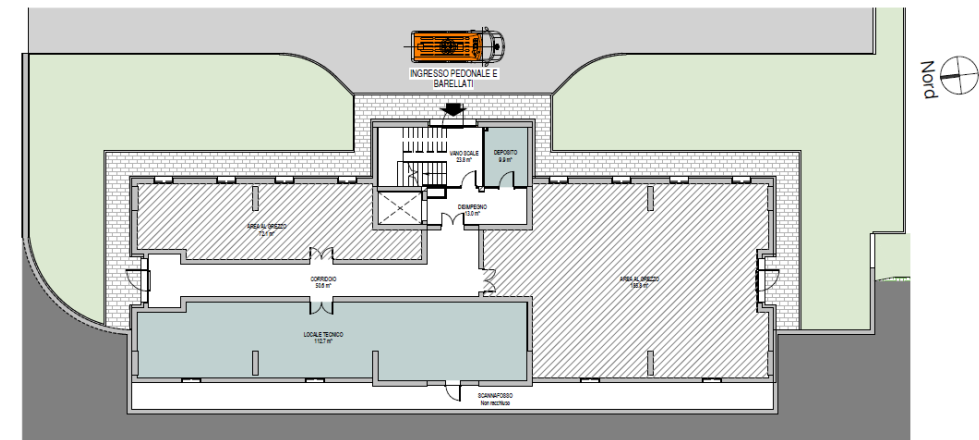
Pianta Piano Seminterrato - Ipotesi di Progetto
